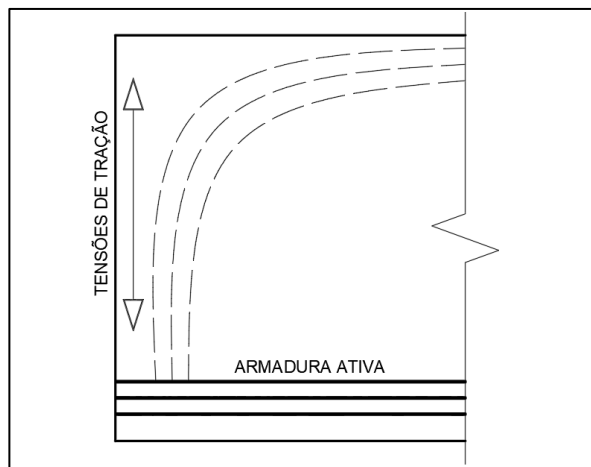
Tensões de tração na face da extremidade (spalling). (Fonte: autor)
